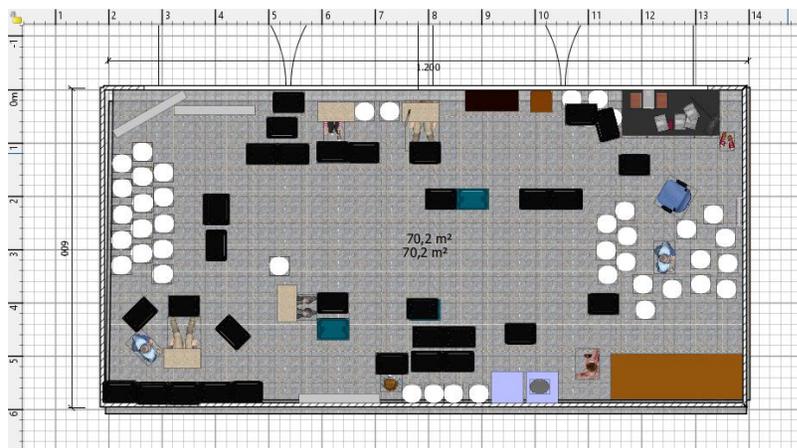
Plano Segundo nivel bodega Cebollas J.T. Autoría propia
